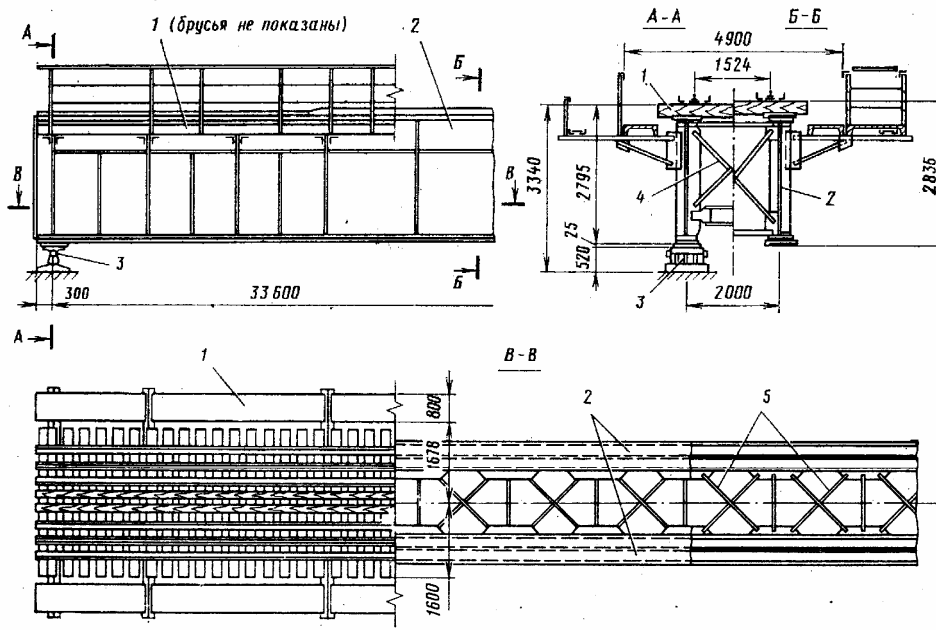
Пролетное строение с ездой поверху на деревянных поперечинах
